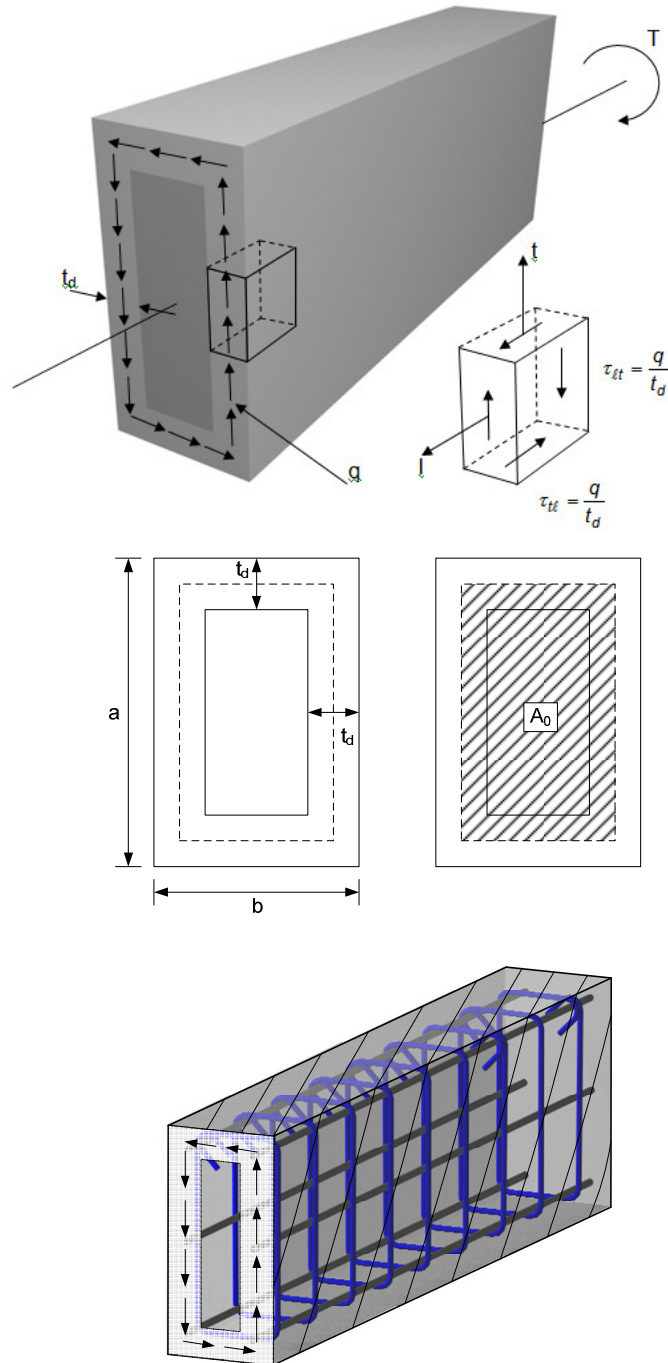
Torção em vigas retangulares de concreto estrutural.
